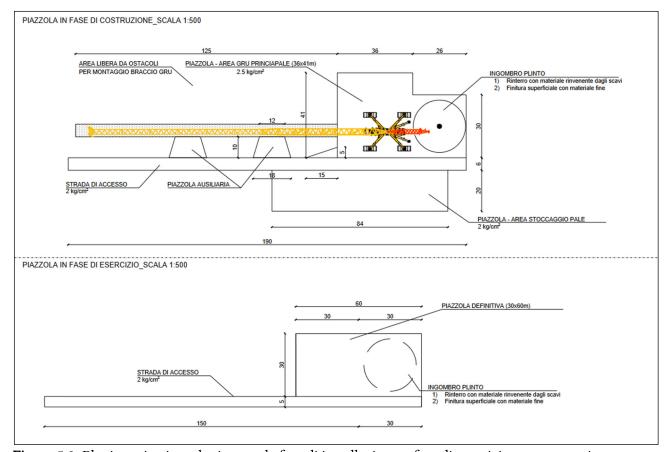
Planimetria piazzola tipo per la fase di installazione e fase di esercizio e manutenzione
